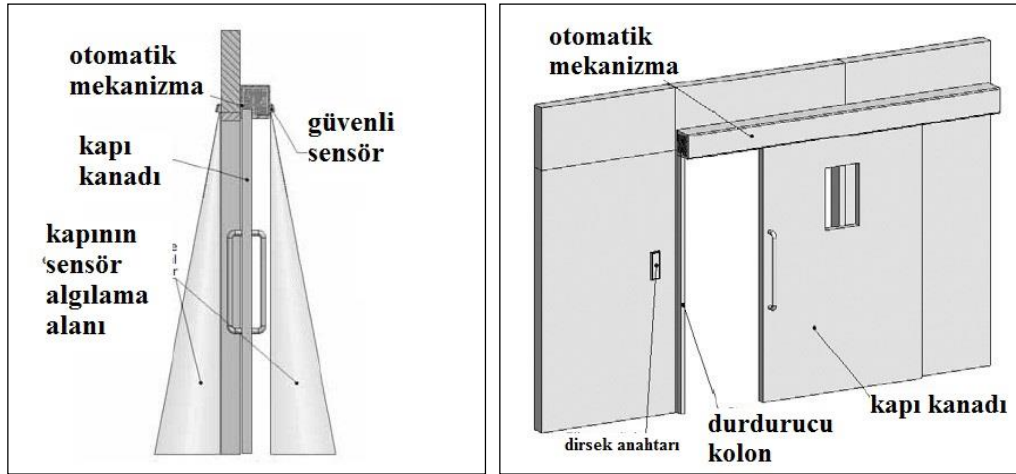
Hermetik kapı plan-kesit detayı (Idoor, b.t)
